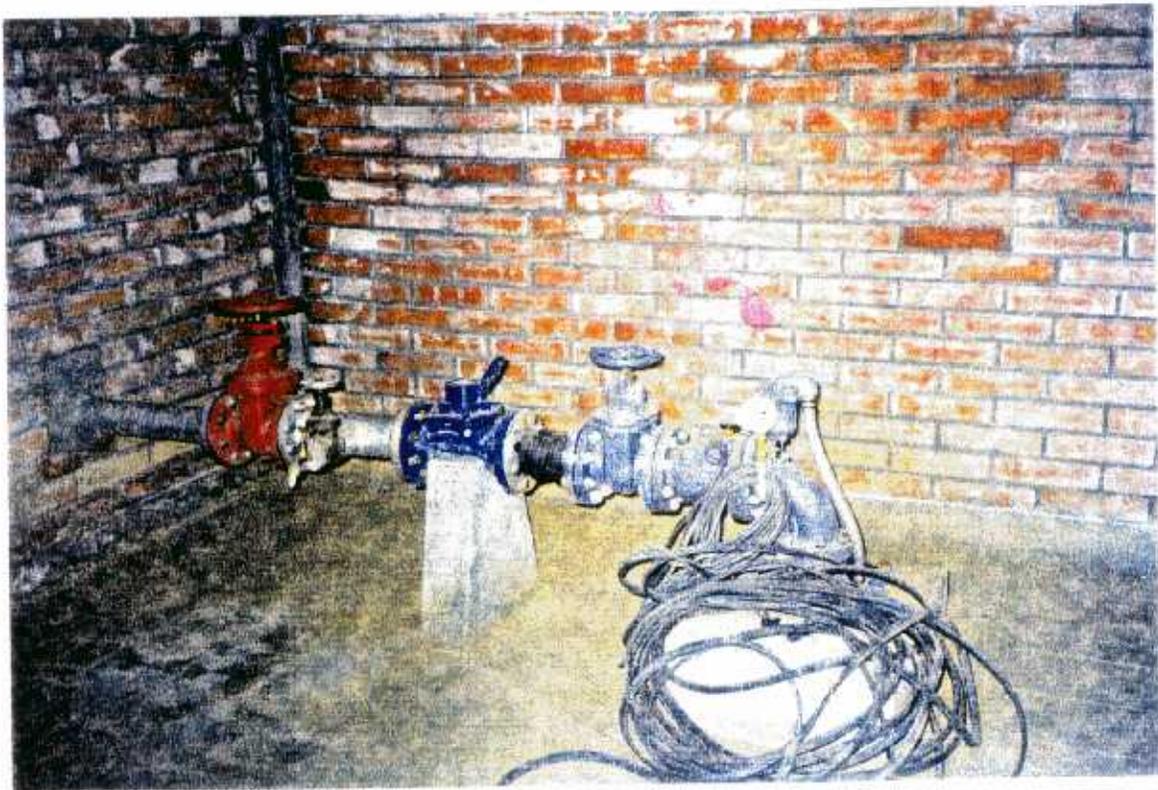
Instalación de Pozo de Bombeo. Planta Tilata. junio 1998
